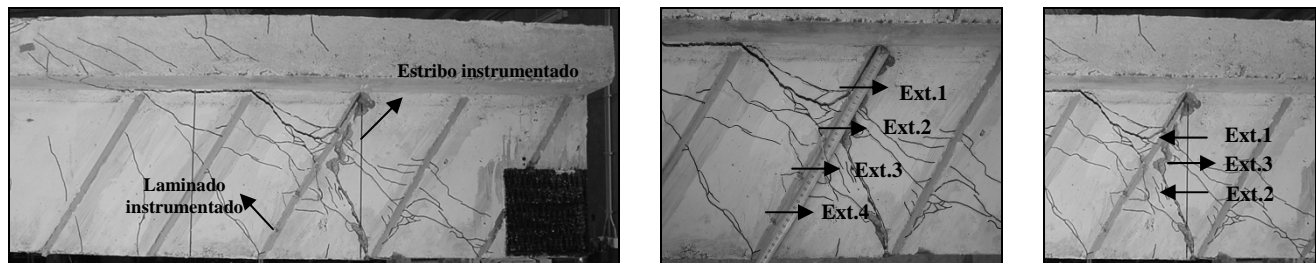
Localização dos extensómetros no laminado e estribo instrumentados da viga 2S-5LI60-A.
